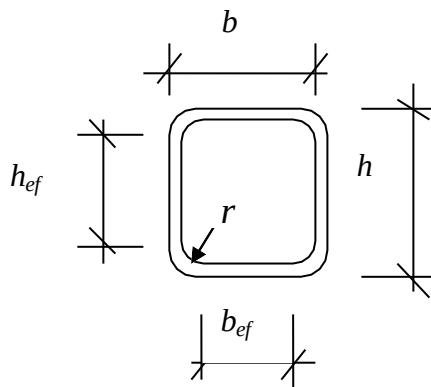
Сечение ГСП. К расчету на местную устойчивость стенок и полок
